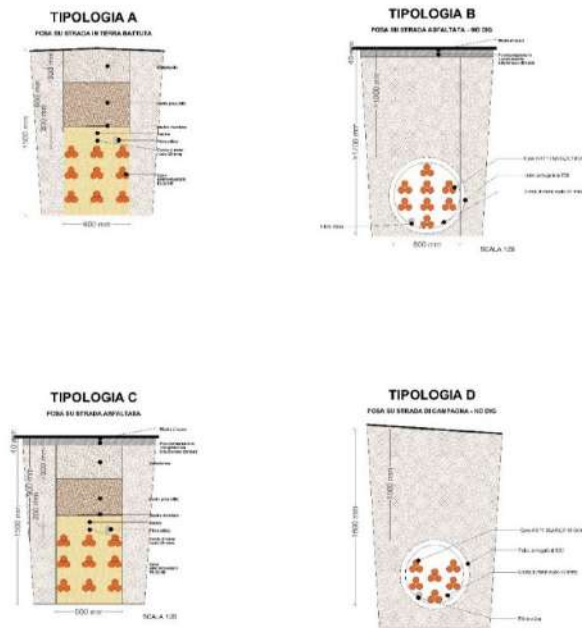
A– Particolare sezione tipo cavo interrato MT e particolari della sezione stradale (elaborato SP9EPD006)
